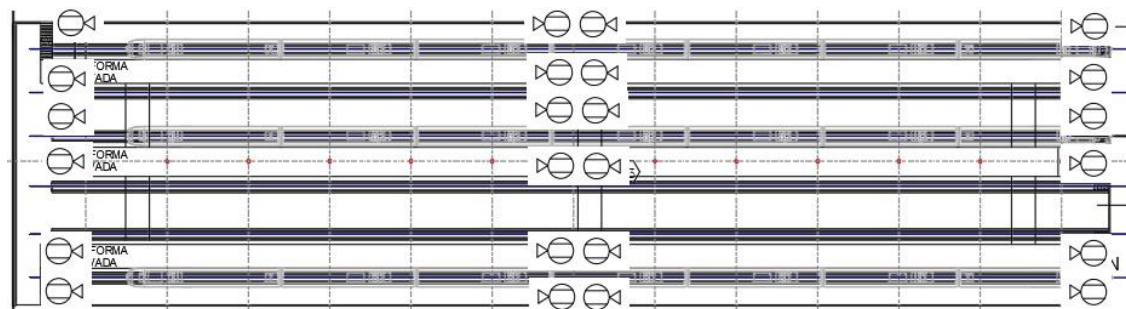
Sistema CCTV Planta Mantenimiento Menor
